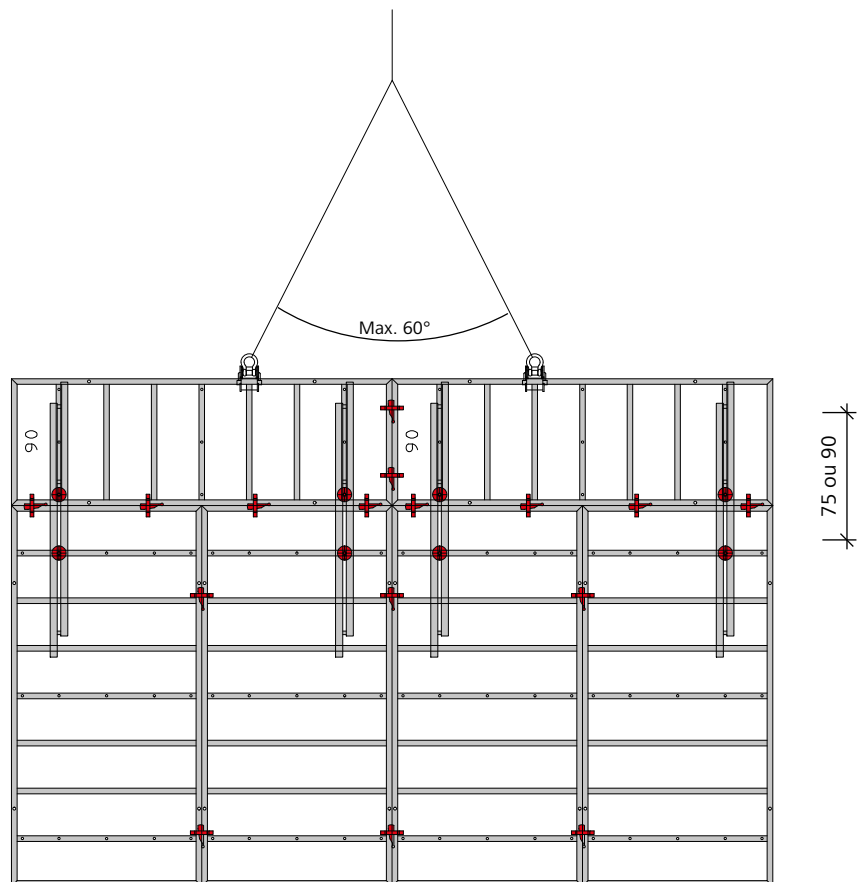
Coffrage rehaussé avec panneaux couchés StarTec de 270/90 ou de 270/75
